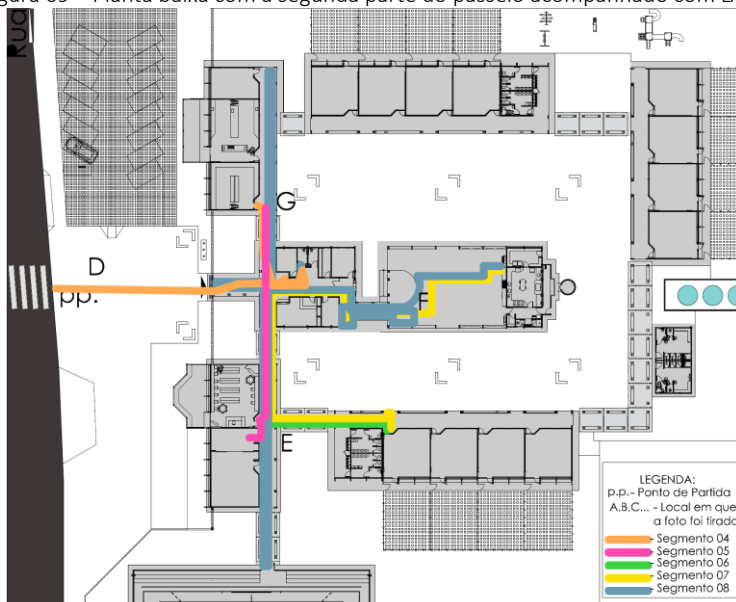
Planta baixa com a segunda parte do passeio acompanhado com LAI
